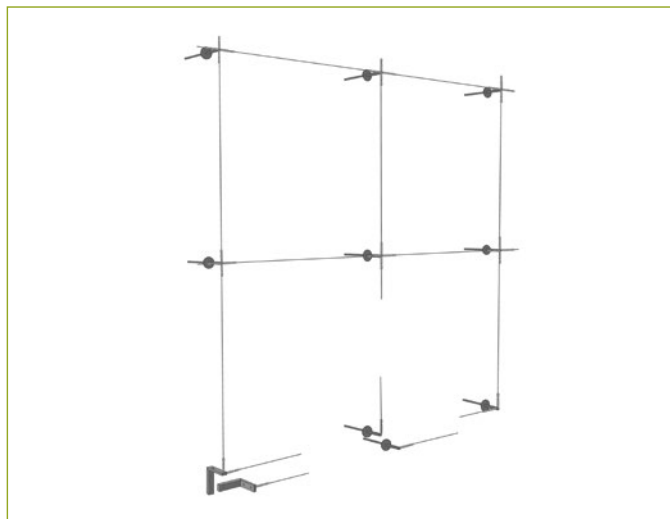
schéma des fixations sur mur d'un système à câbles. Dessin : C. Houel.
